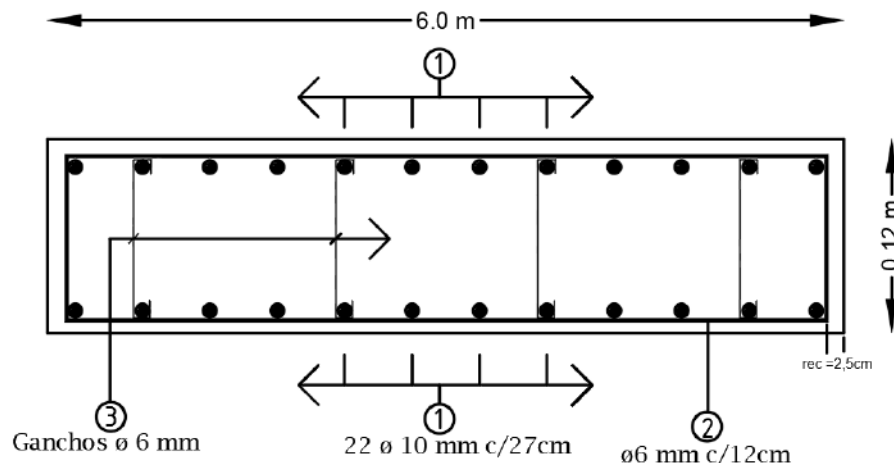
Esquema de armadura de los tabiques – Fuente de elaboración propia
